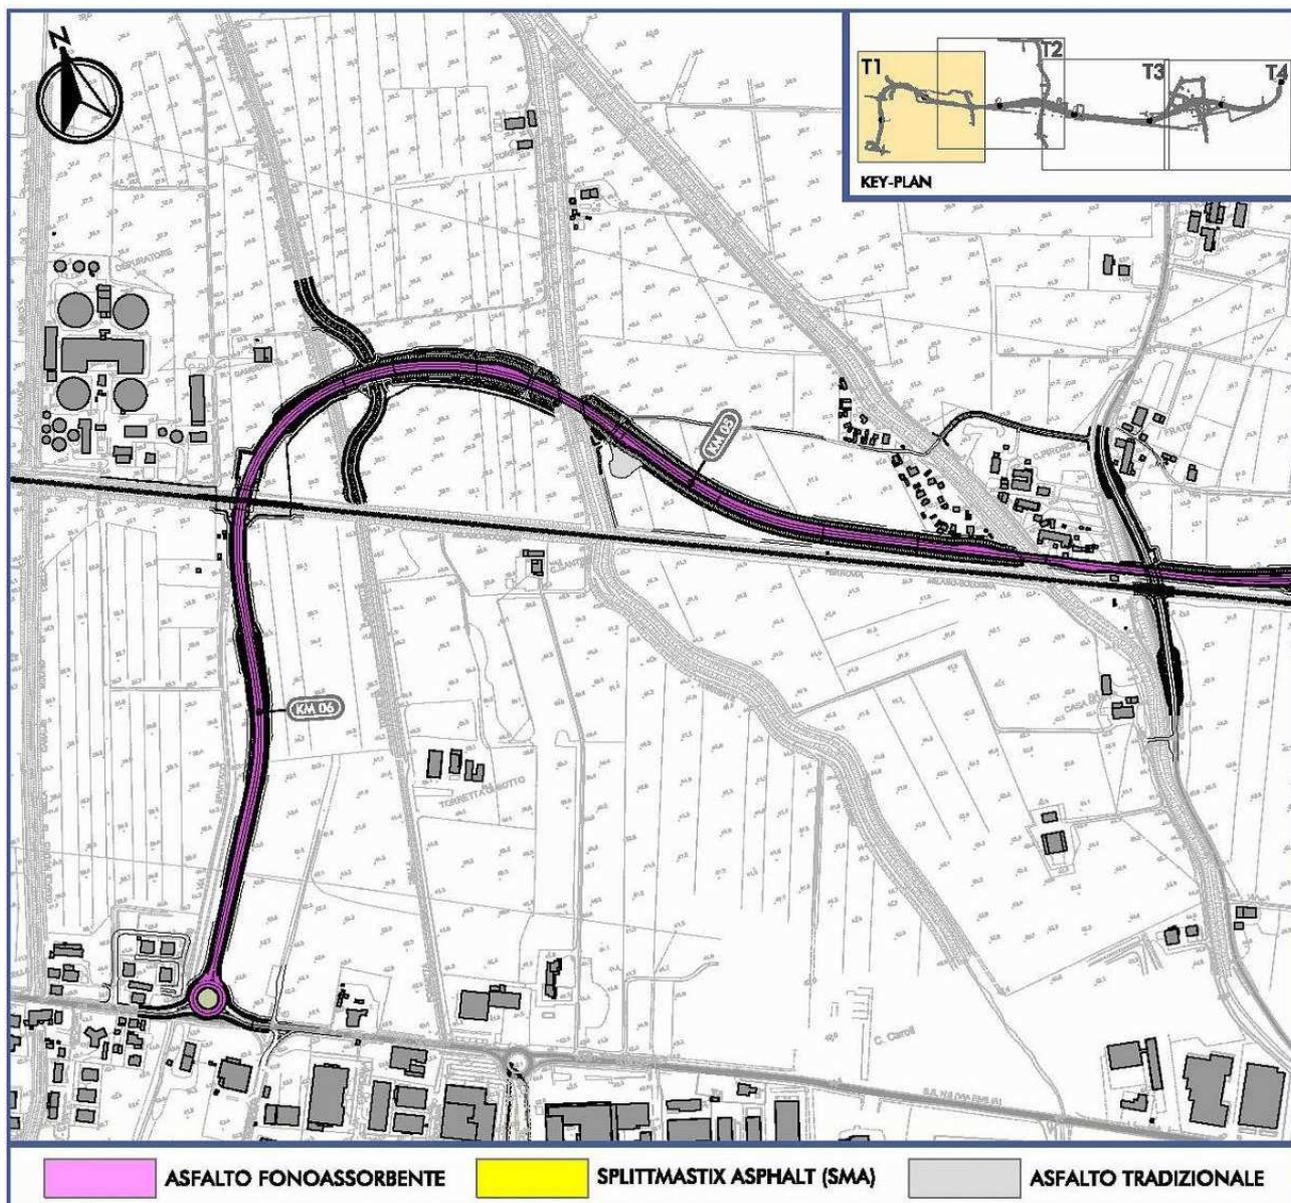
PAVIMENTAZIONI STRADALI DI PROGETTO NEL TRATTO TRA LA PK 4+500 E IL FINE INTERVENTO A CORTE TEGGE
